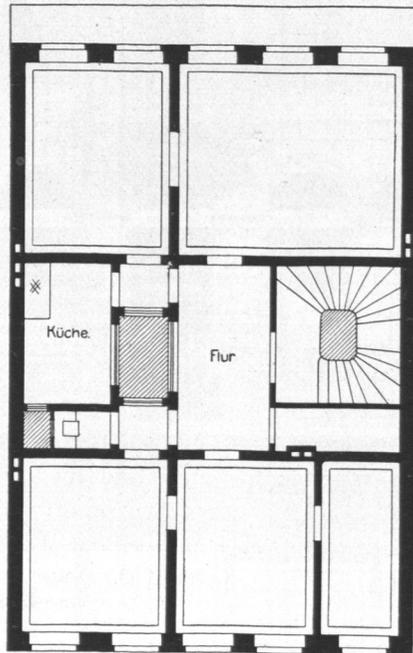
Haus Ferdinandstraße Nr. 18, Grundriß.
